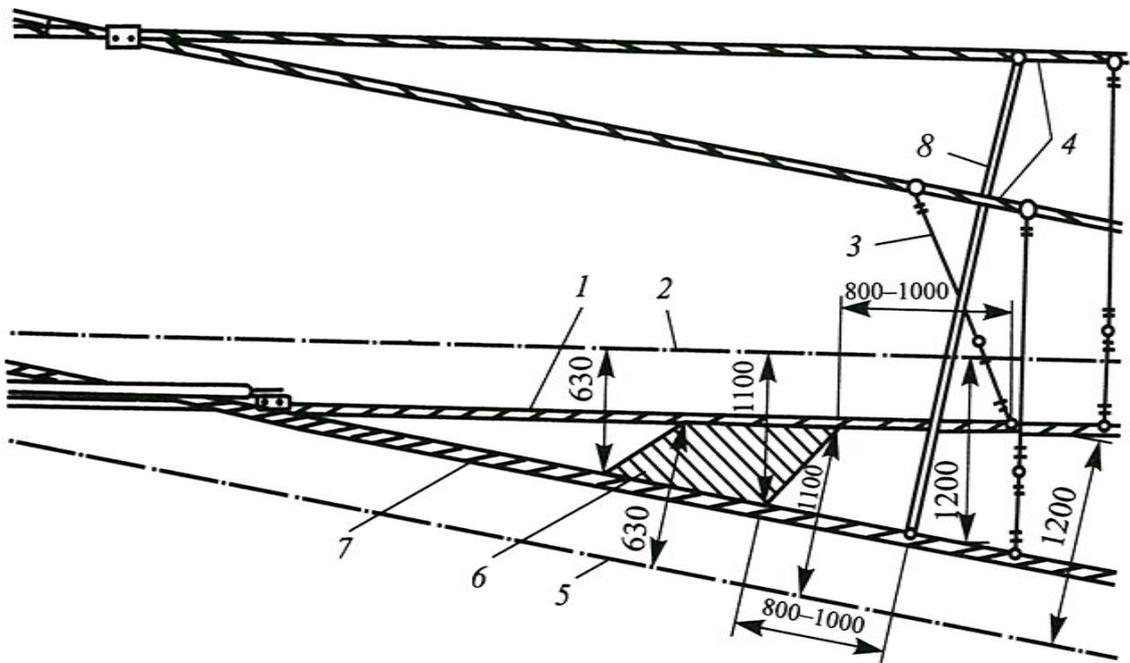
Перекрестная жесткая распорка и гибкая струна на воздушной стрелке: 1 и 7 — контактные провода прямого пути отклоненного путей; 2 и 5 — оси прямого и отклоненного путей; 3 — гибкая звеньевая струна; 4 — несущие тросы; 6 — зона подхвата; 8 — жесткая распорка
